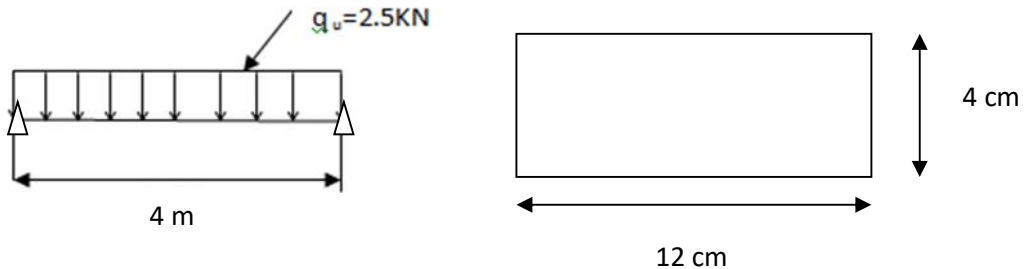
schéma de calcul des poutrelles à l'ELU
